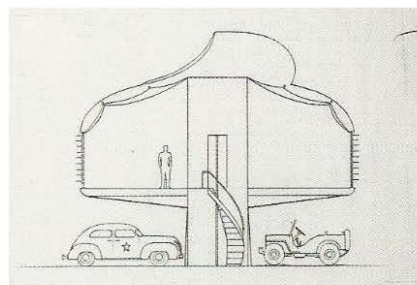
Alzado Wichita House, dibujo Don Royston, L., 1945.
